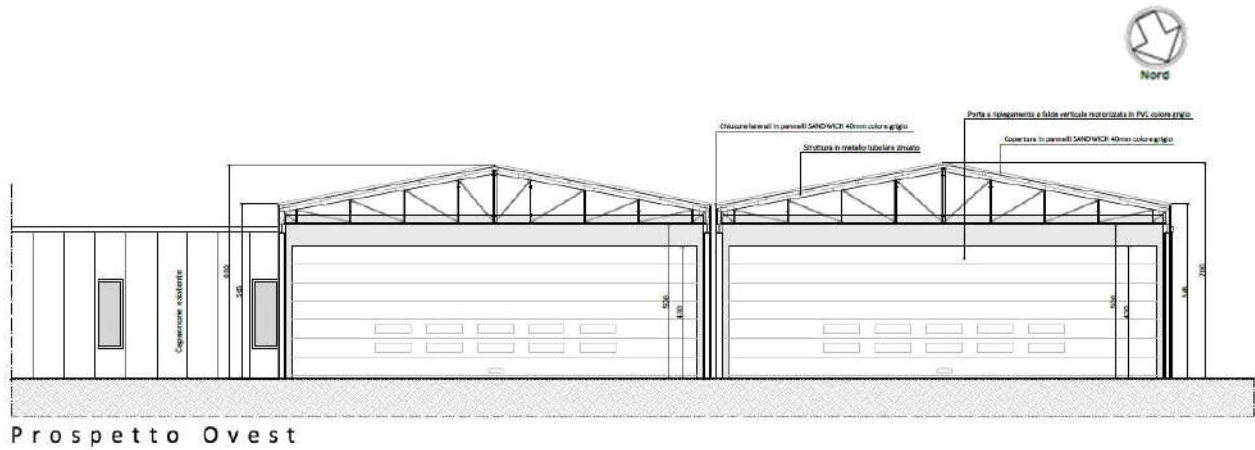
Prospetto Ovest dell'ampliamento in progetto
